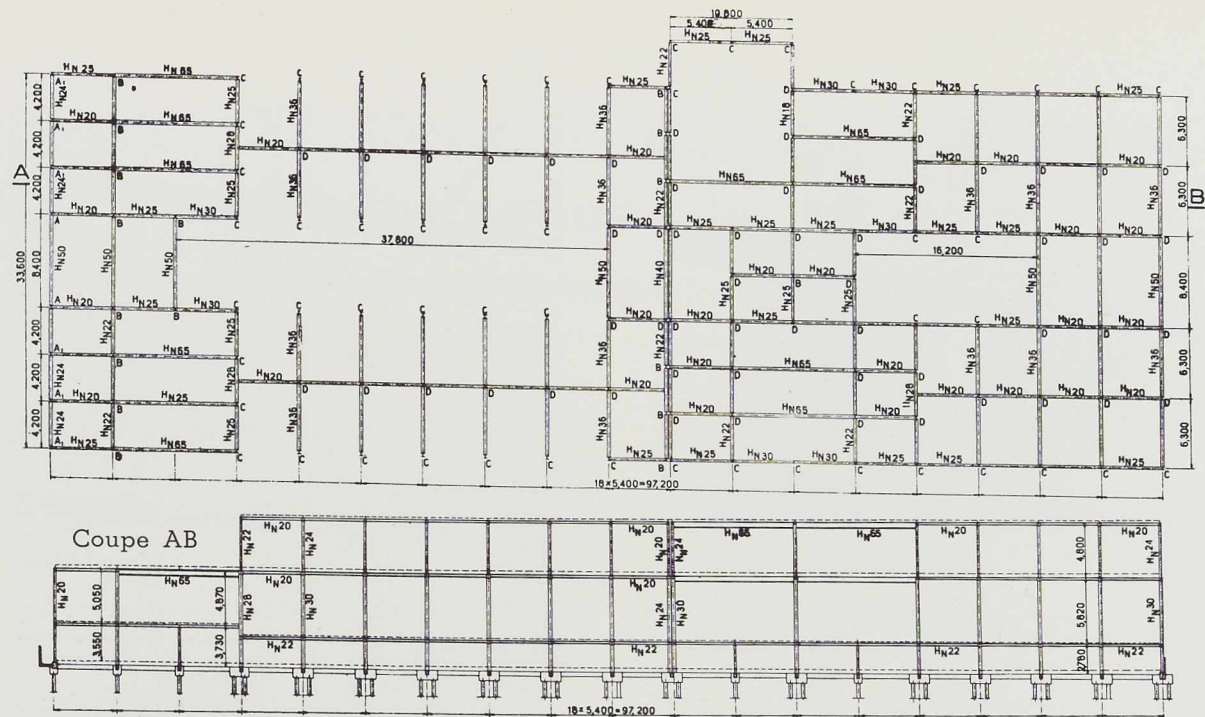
Vue en plan avec coupe AB de l'ossature du rez-de-chaussée.
